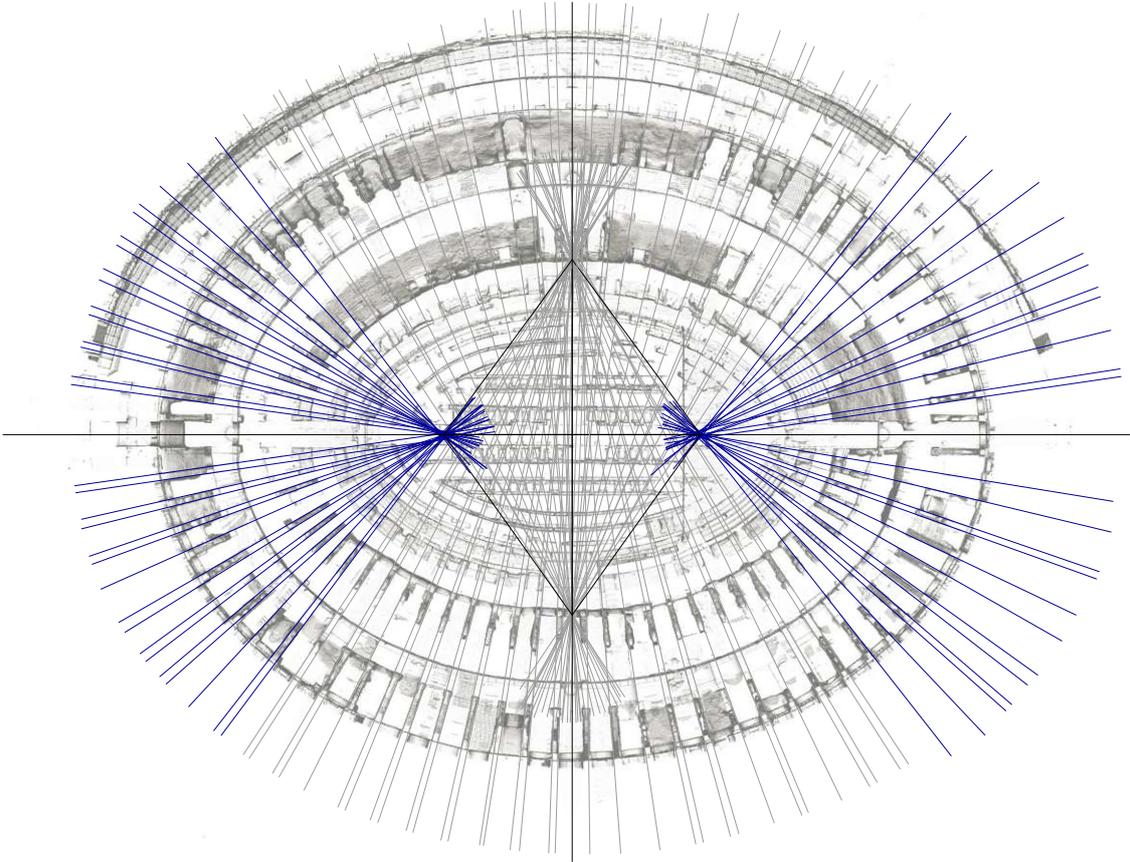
Verlängerung der Wandaußenkanten des Kolosseums im Grundriss⁹⁹
